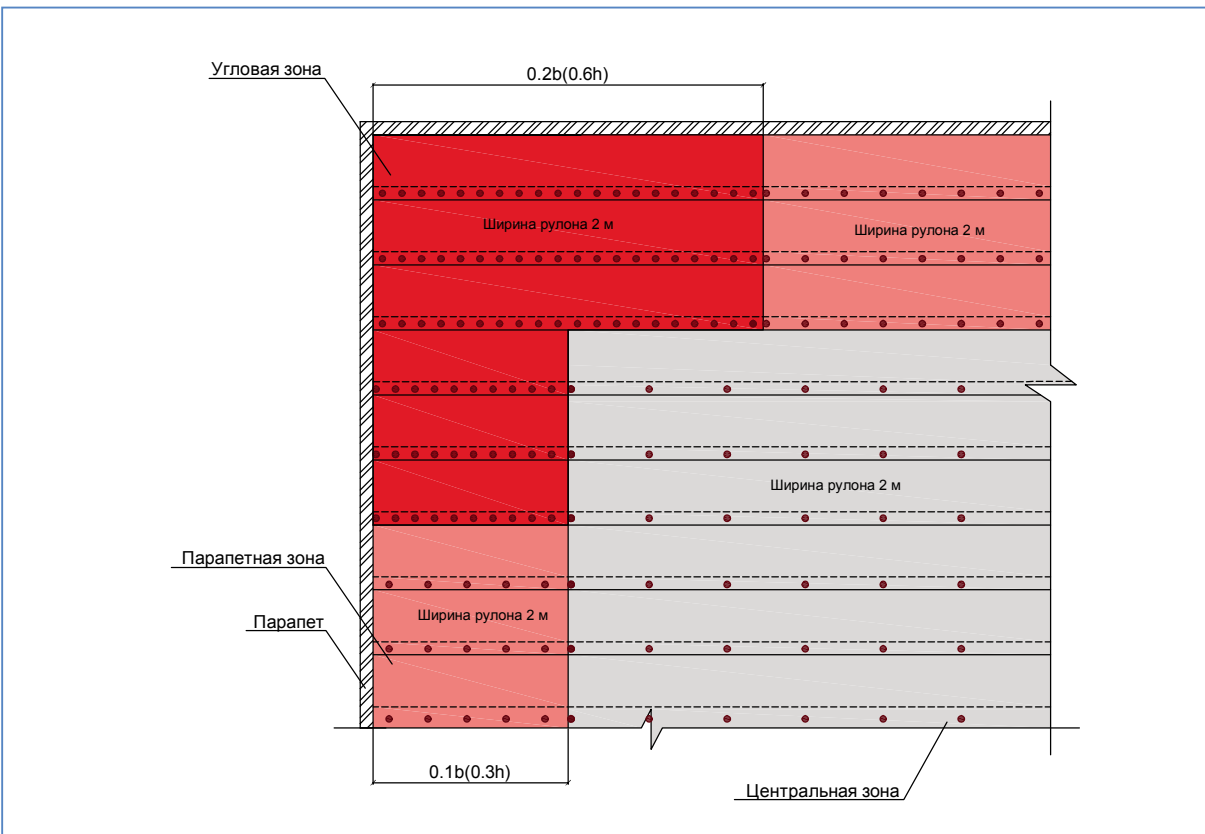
б Вариант раскладки и крепления полотнищ по бетонному основанию
